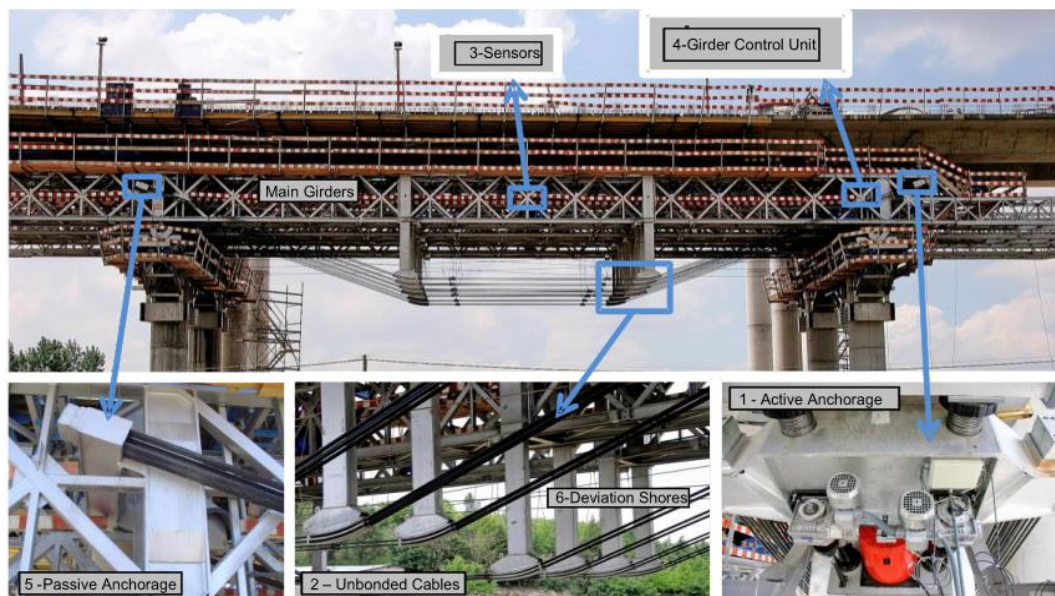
| 21 – Exemplo de um cimbra autolancável com OPS integrado. Pormenor dos seus elementos principais [18]
